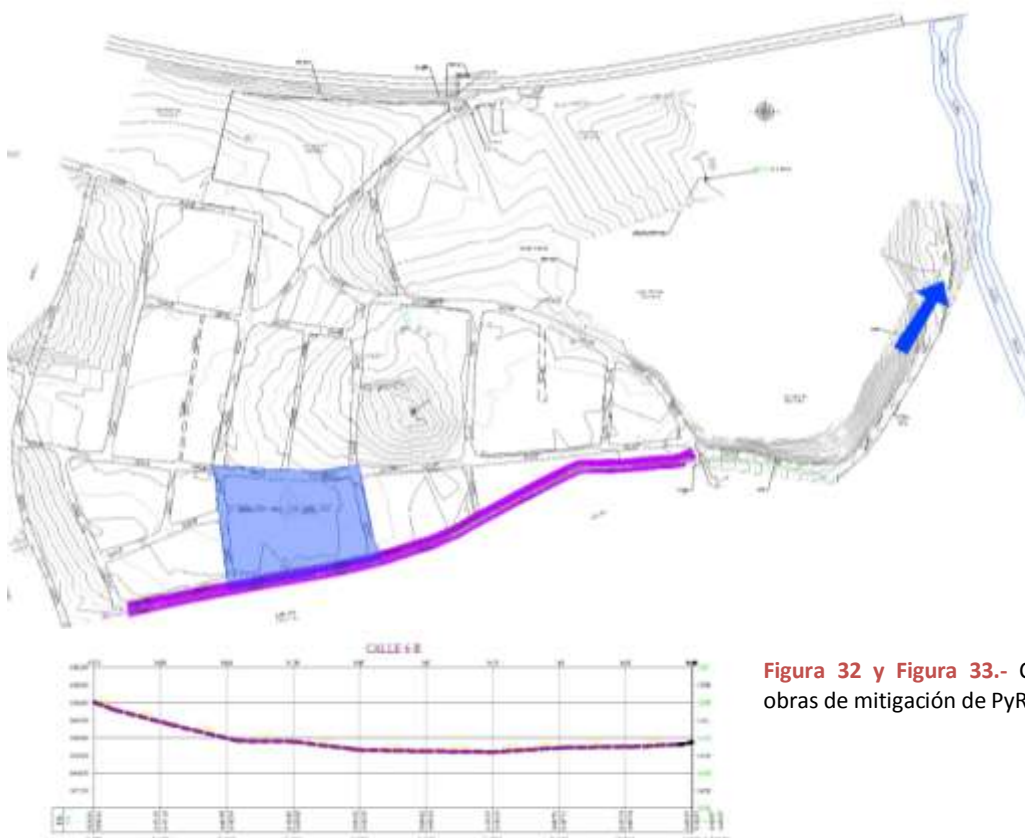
y Figura 33.- Canal de drenaje y obras de mitigación de PyR en planta y perfil
